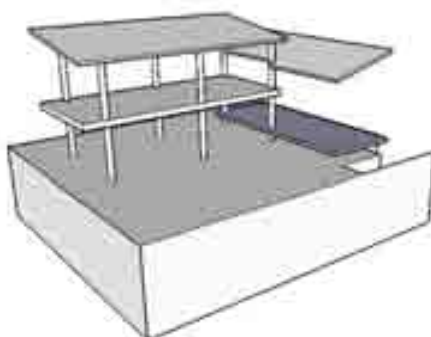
Ossatura da edificação, com os elementos estruturais verticais (pilares) e horizontais lajes. Fonte: documentação do ARCEN/PMJP e levantamento de campo. Realização da maquete: Roberta Xavier da Costa. 2010.
